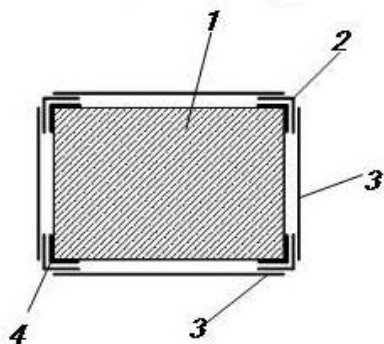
Наружная усиливающая конструкция колонн: 1 – железобетонная колонна, 2 – продольные стальные уголки, 3 – поперечные соединительные планки, 4 – обмазка из цементно-песчаного раствора с добавлением жидкого стекла
